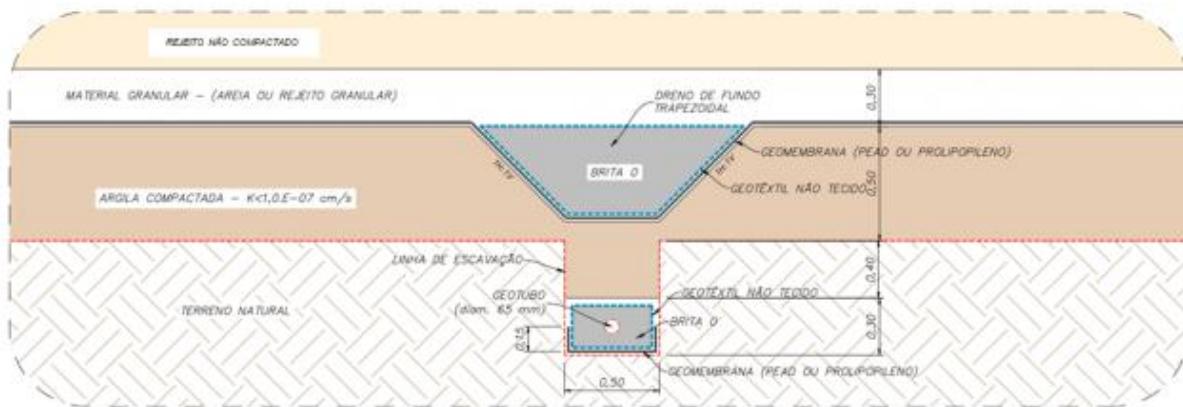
Detalhe- impermeabilização dos dispositivos de drenagem interna Fonte: EIA, 2024
